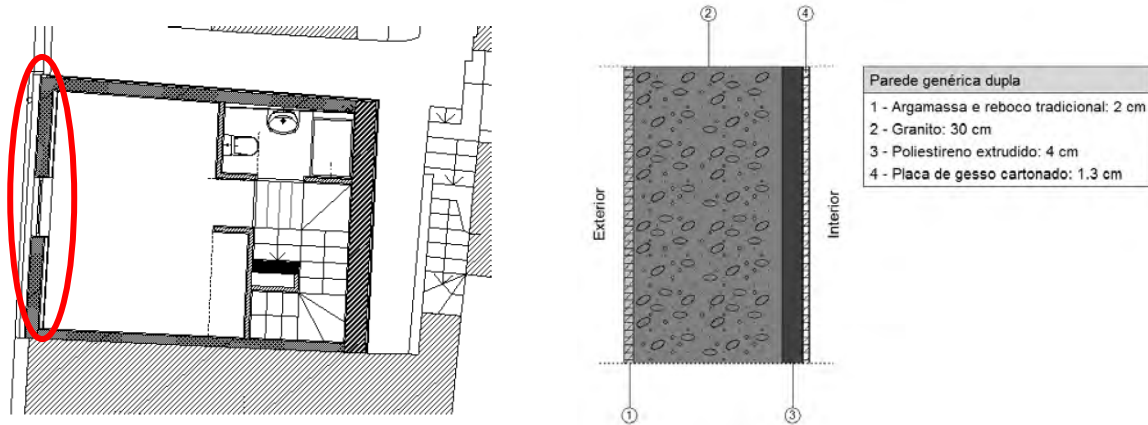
Identificação e pormenor construtivo da parede Pe2.
